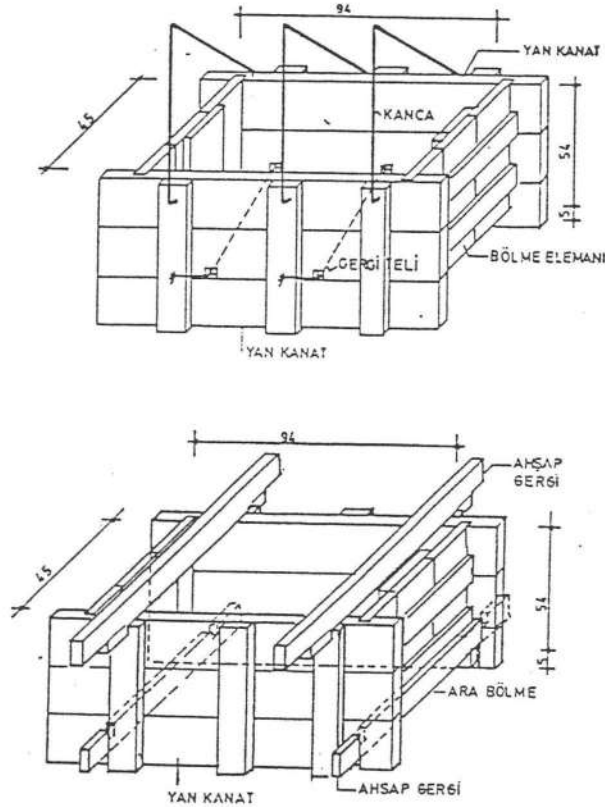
Geleneksel Kerpiç Tuğlası Döküm Kalıpları
